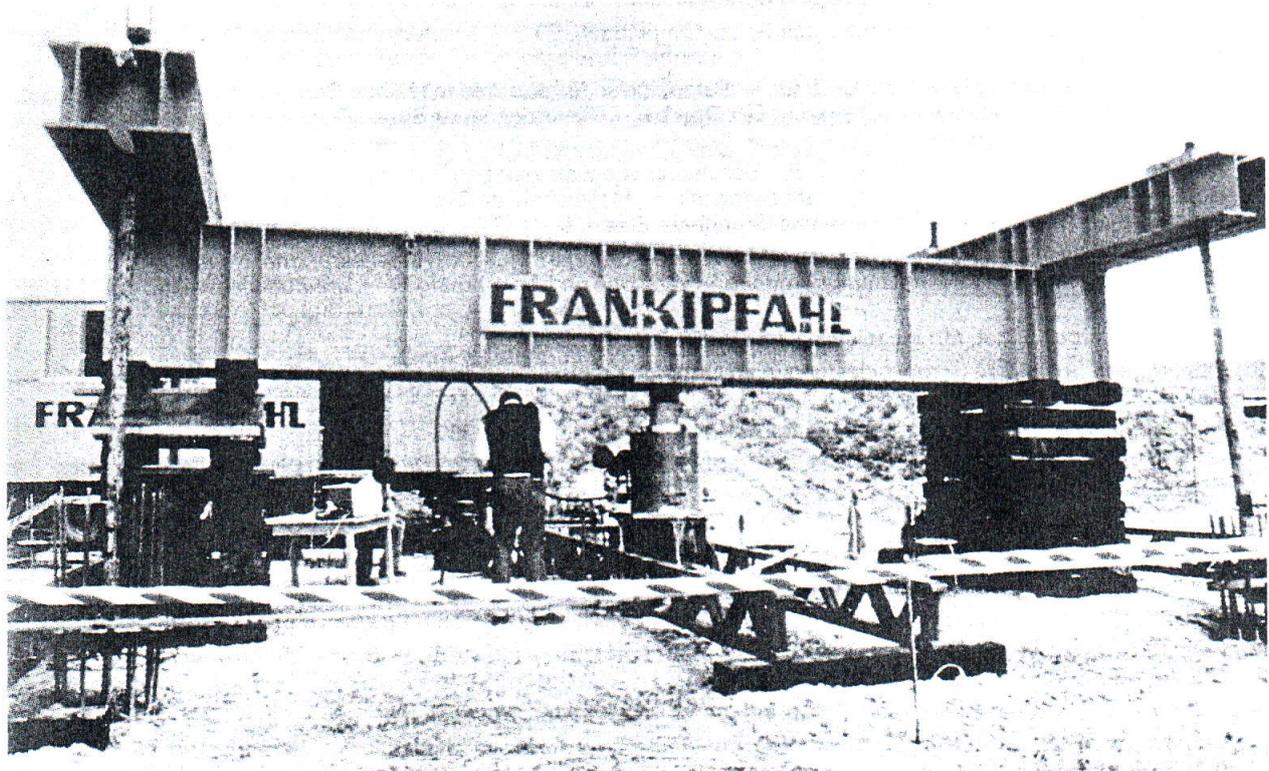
Probelastung an Ortbetonrammpfählen der Schwarzbachtalbrücke unter vorgegebener Bremsbelastung nach Bild 23
